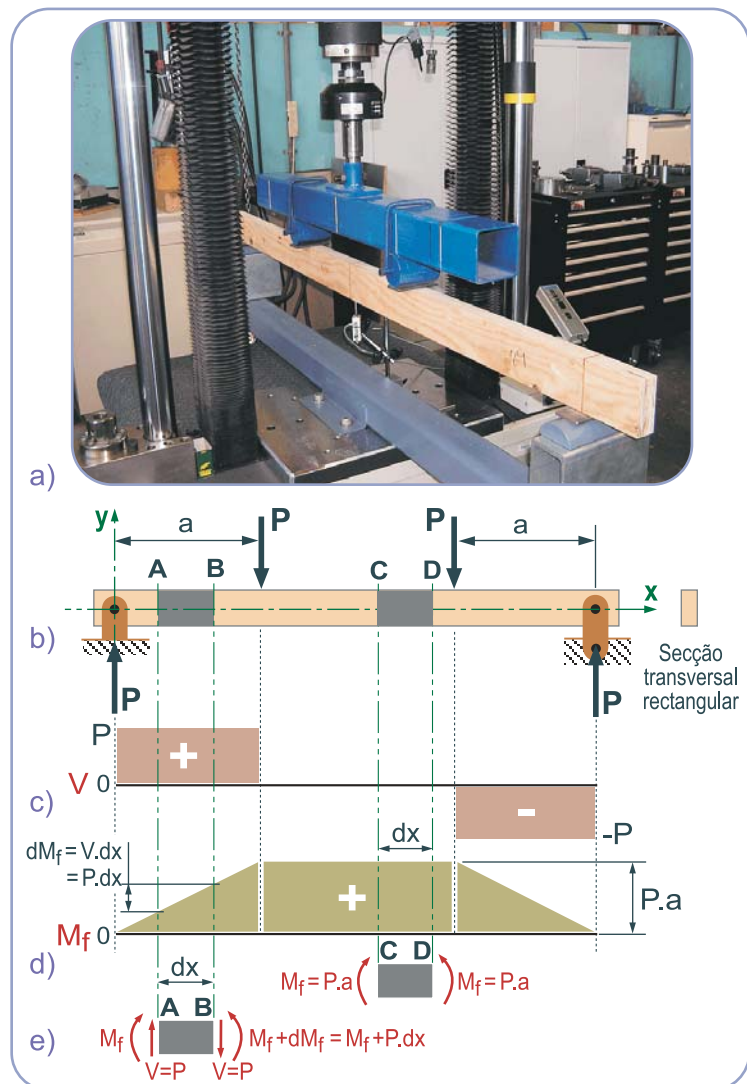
Viga em madeira sujeita a ensaio de flexão em 4 pontos.
